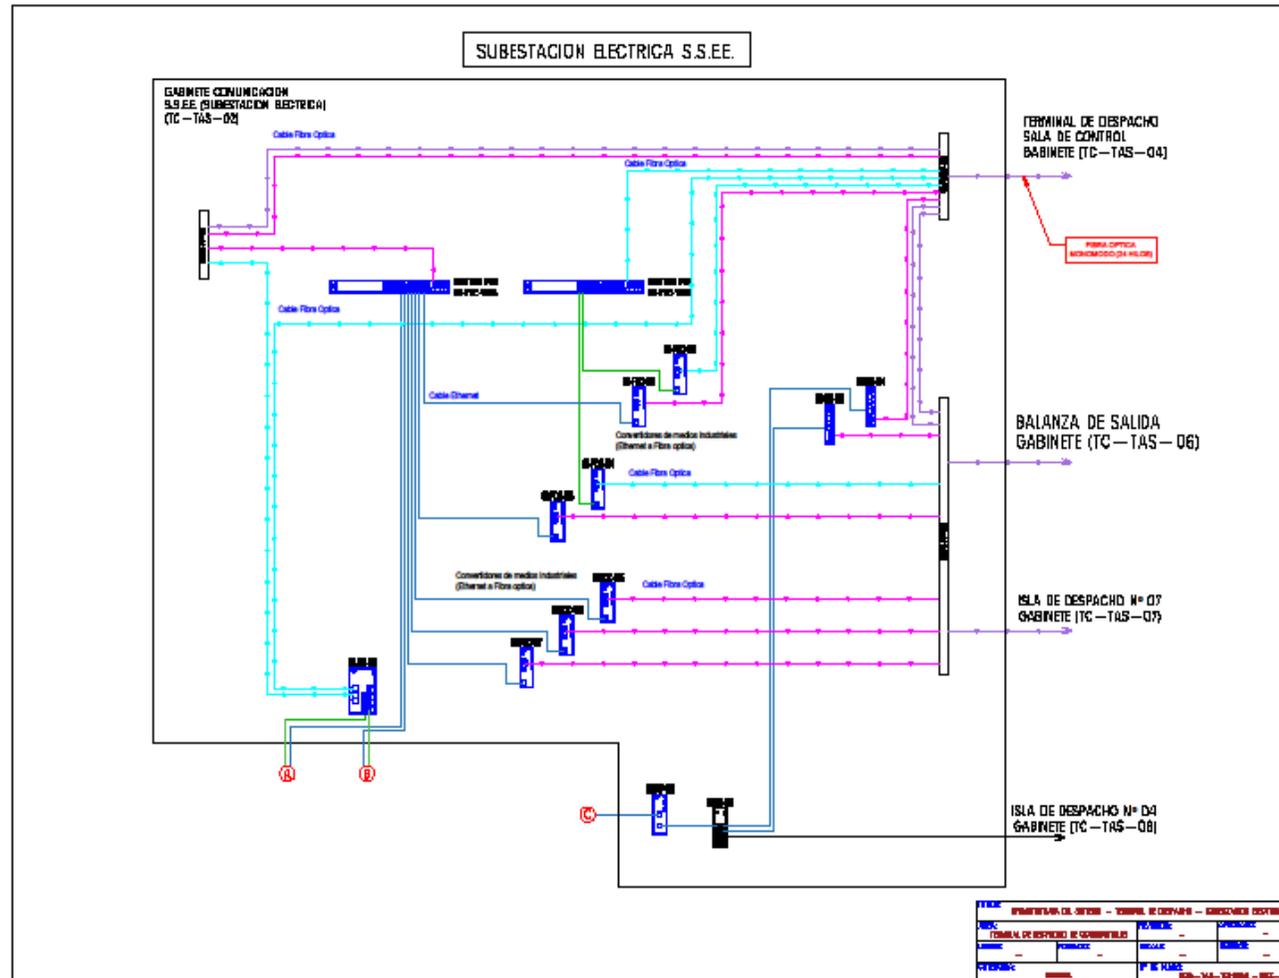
Arquitectura del sistema en subestacion electrica, parte 1
